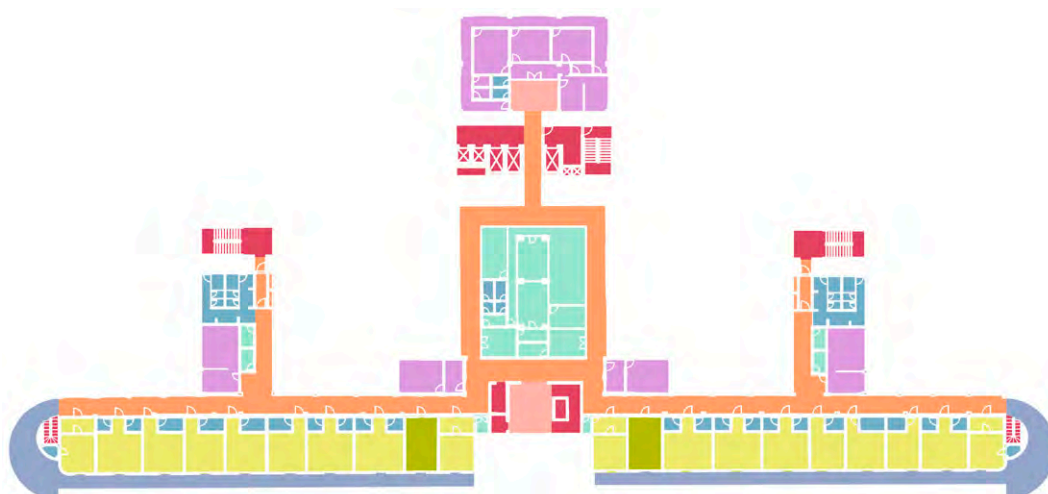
Planta baixa - terceiro pavimento. Distribuição dos usos pelas alas e blocos prismáticos
